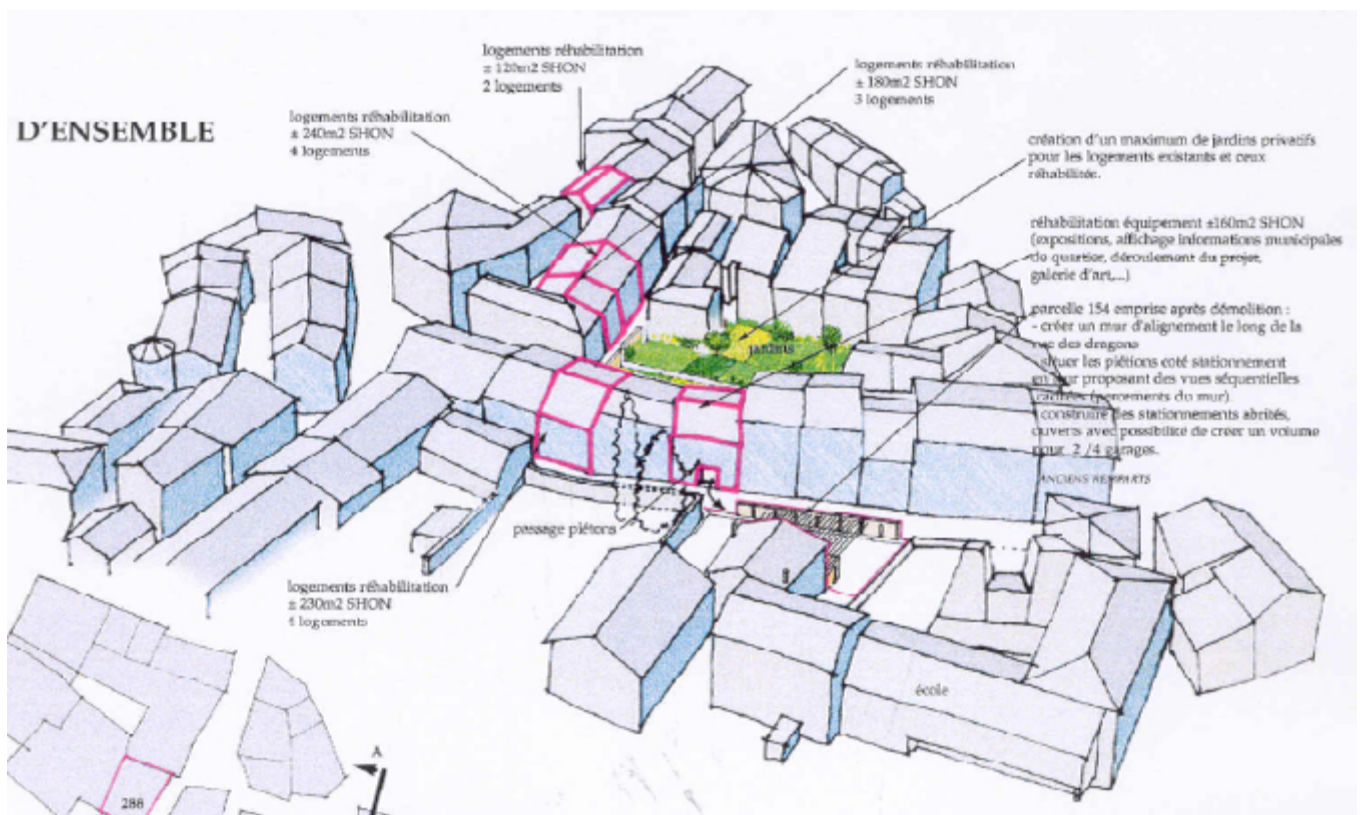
Intervention prioritaire sur bâti, source Pierron et Terrière
